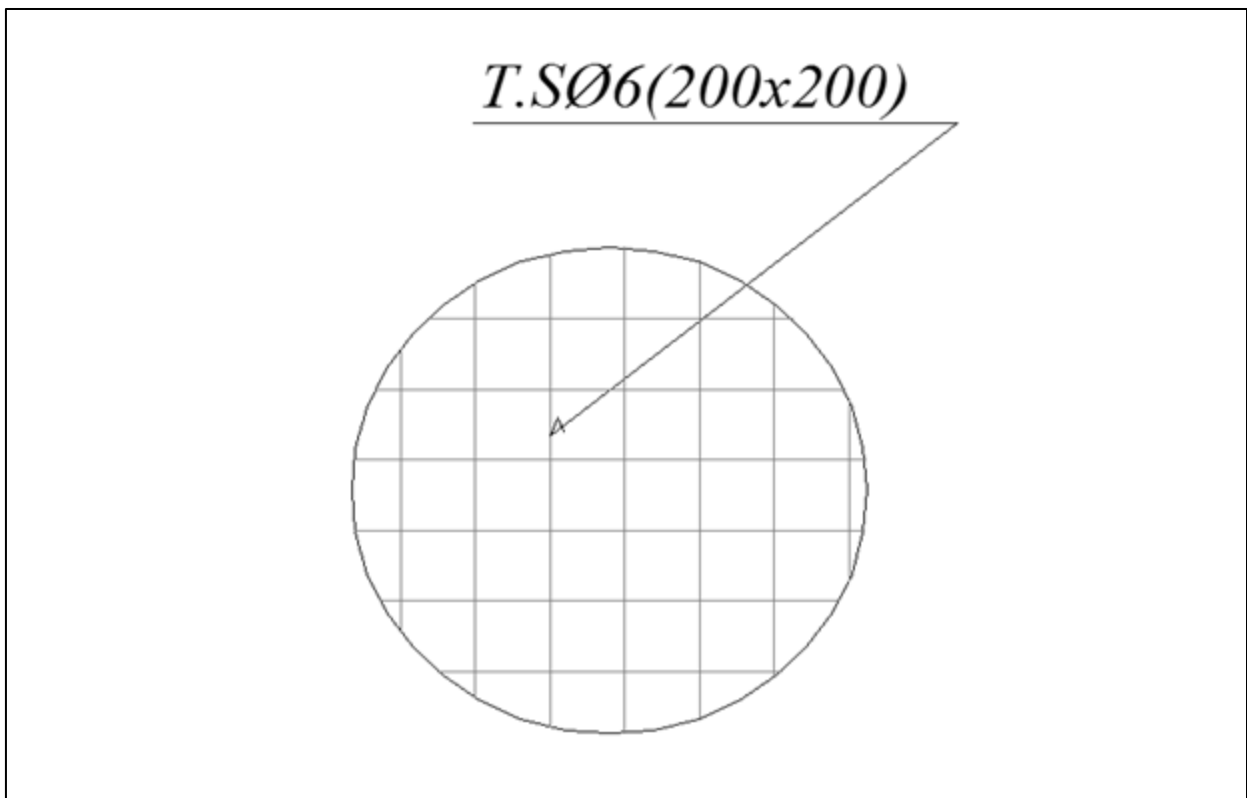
Schéma de ferrailage de la dalle de compression.
